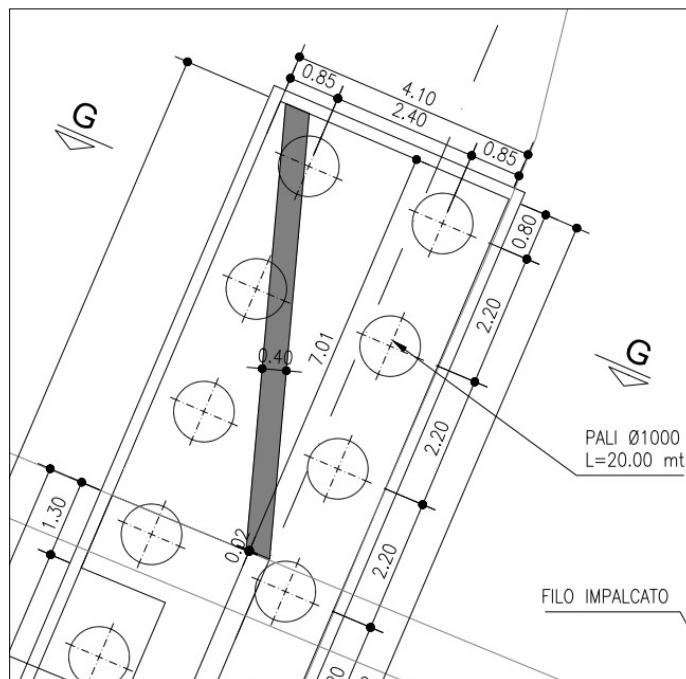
Posizione planimetrica del muro d'ala lato Bologna – Allargamento Nord
